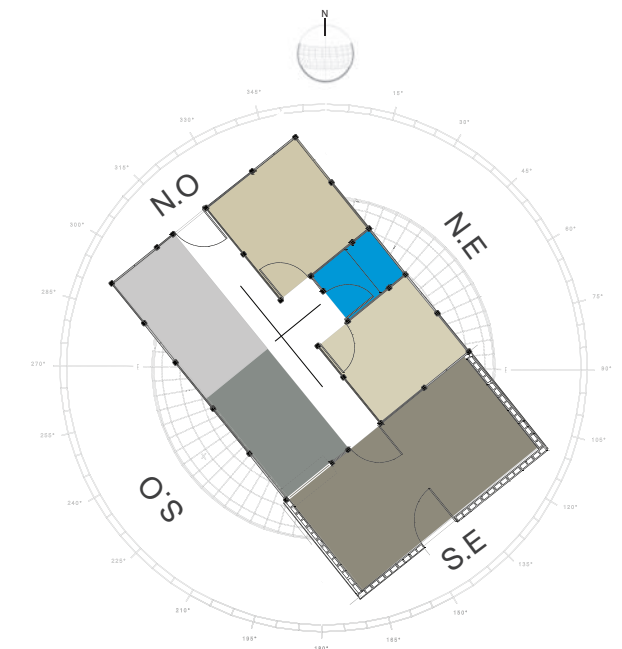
Planta diagramática con indicación de posicionamiento de la vivienda. Fuente: Autor.
